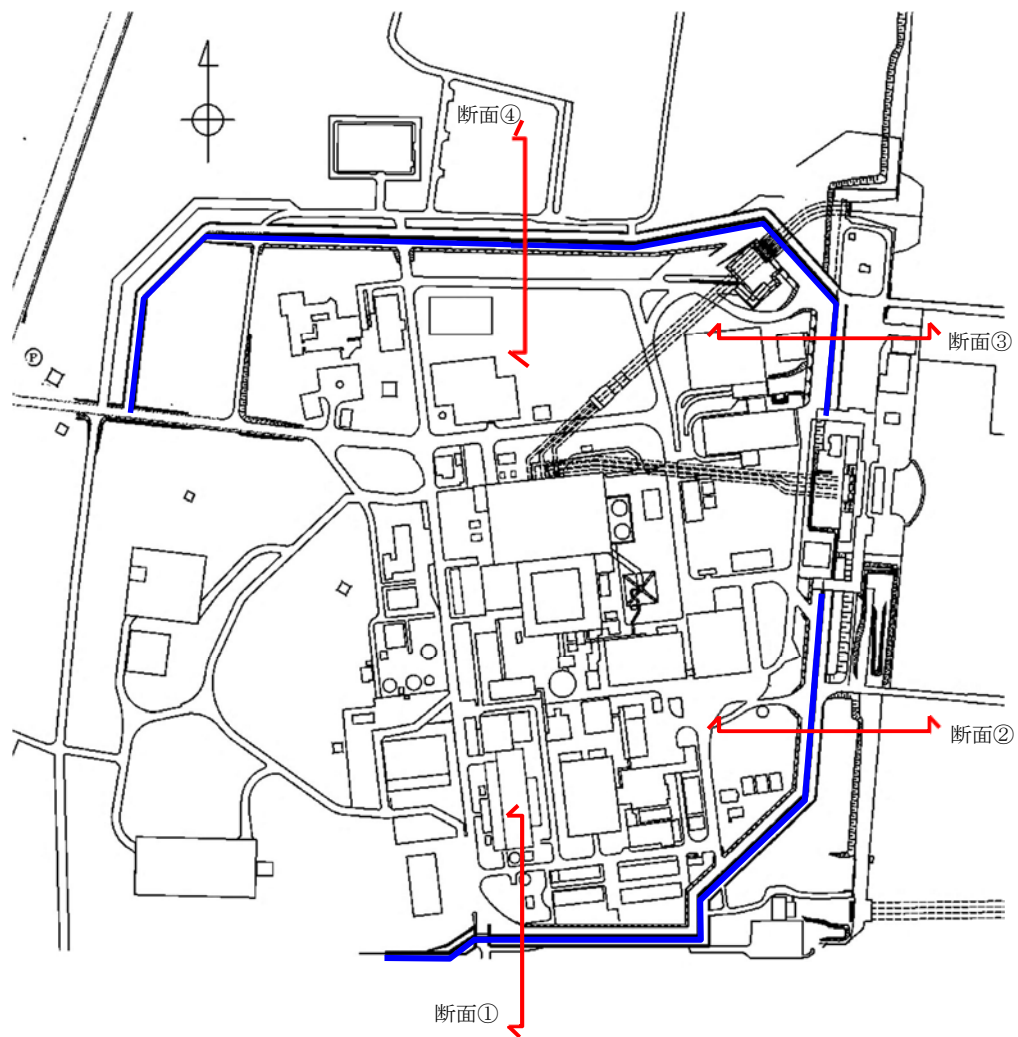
鋼管杭鉄筋コンクリート防潮壁の評価対象断面位置図
